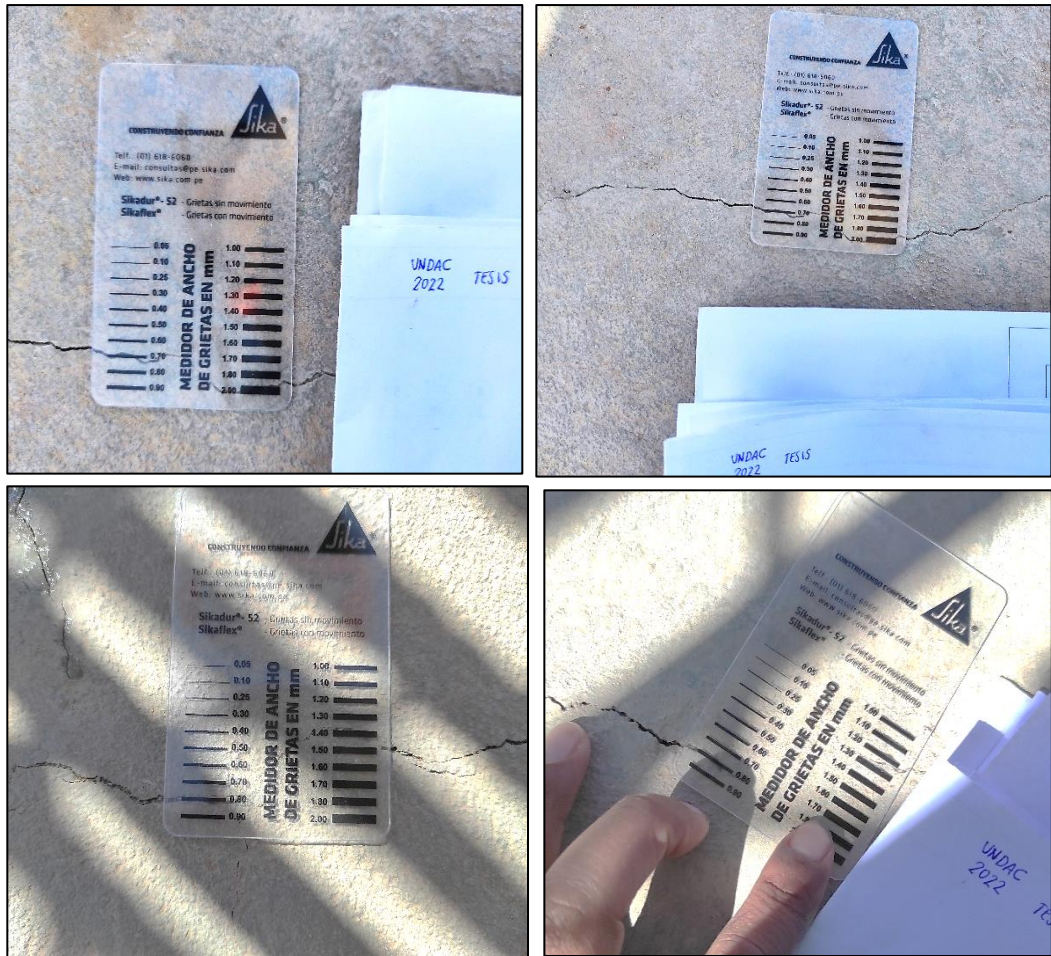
GC1 y GC1 control de dimensiones de fisuras en su estado endurecido.
